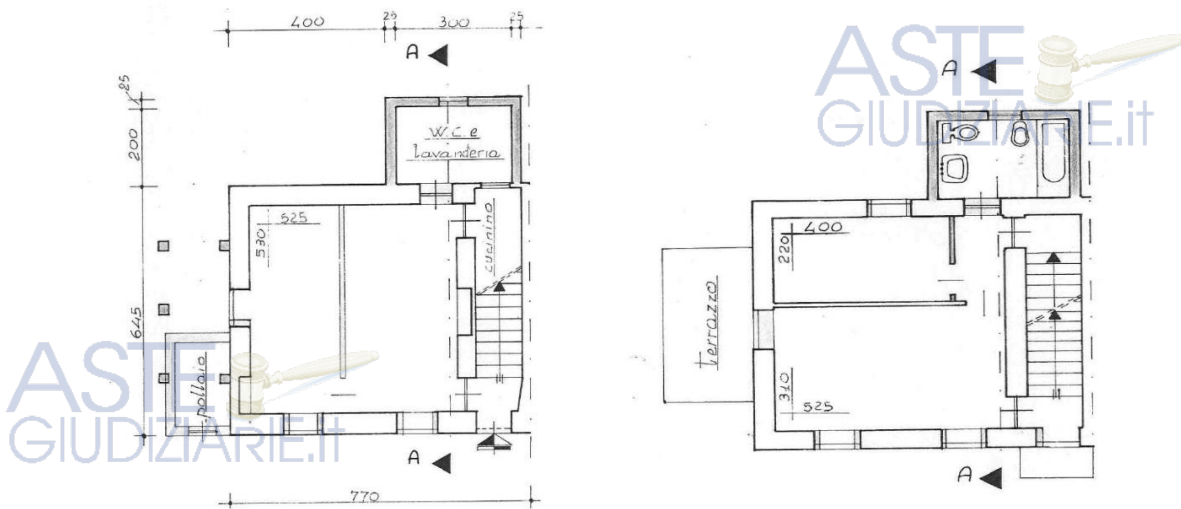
Estratto Concessione 27/1982 Piante ai vari piani
